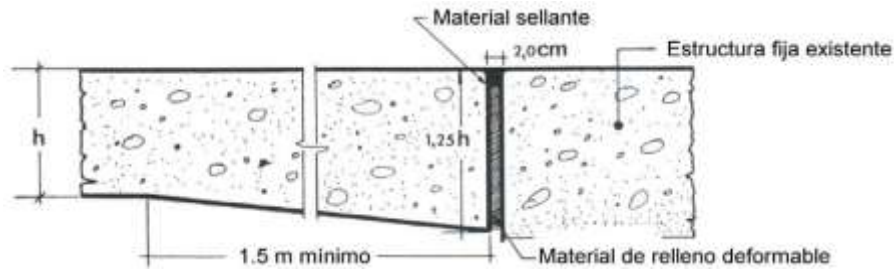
, Junta de Expansión Tipo 1.
